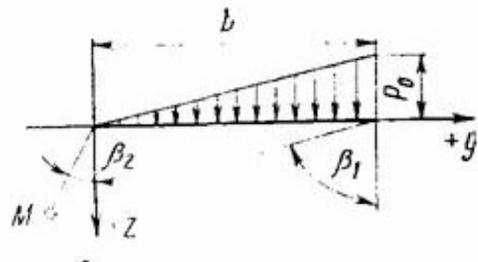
Схема расчета напряжений при треугольной нагрузке
